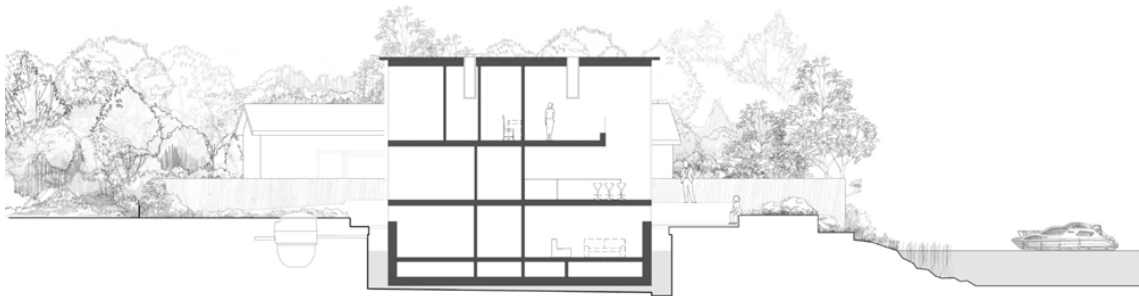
Corte Longitudinal de Amphibious House de Baca Architects (Fonte_21)
